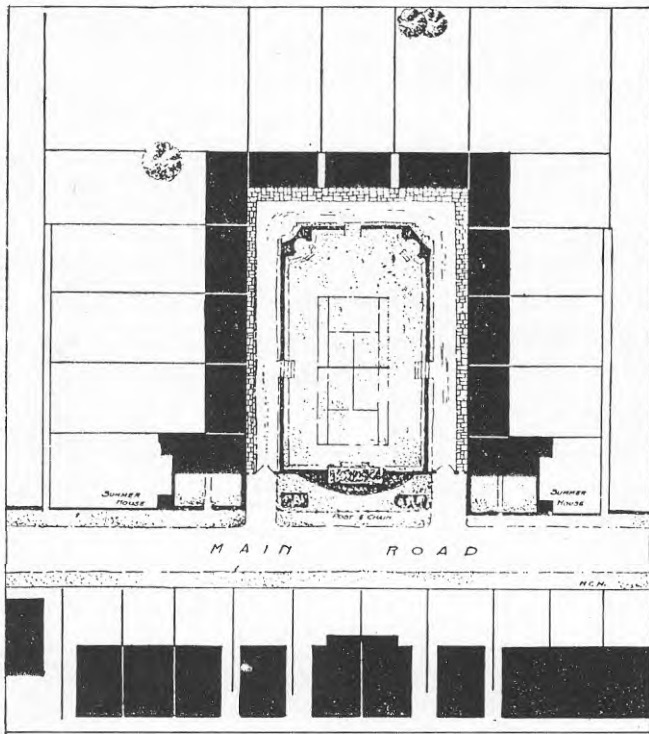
och Fig 2.6 Town Planning in Practice (1909) blev mönsterbildande för planeringen av trädgårdsstäder även utanför Enland.
